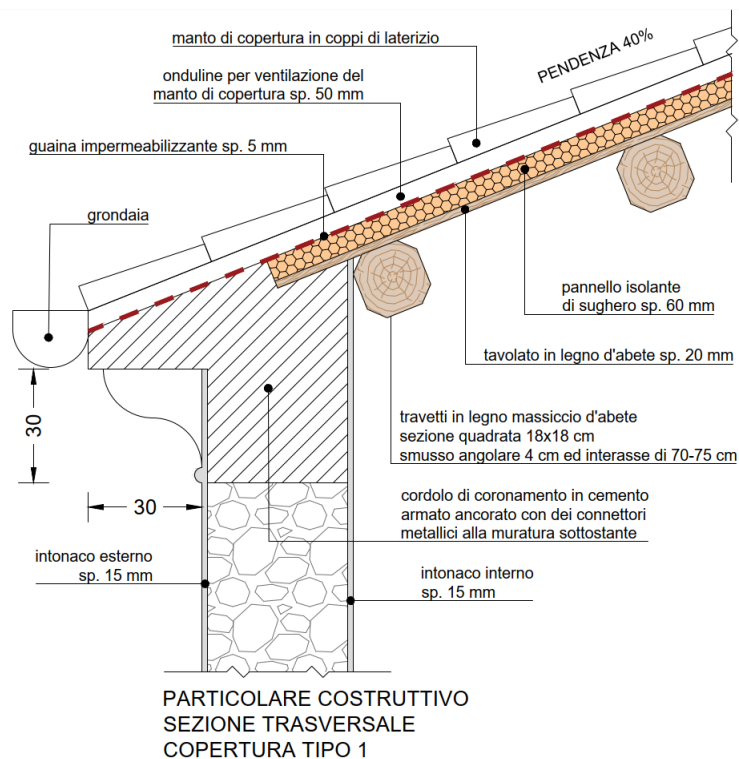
Particolare costruttivo copertura tipologia 1 - Sezione trasversale
